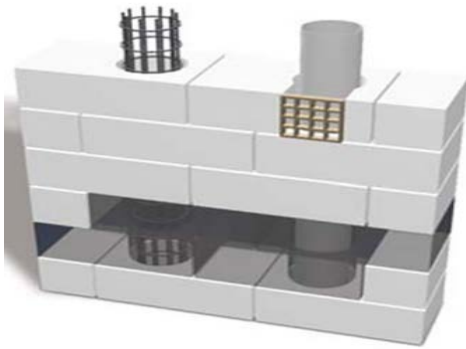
Принципова схема влаштування вертикальної залізобетонної колони та вентиляційного каналу в стіні з використанням газобетонних О-блоків
